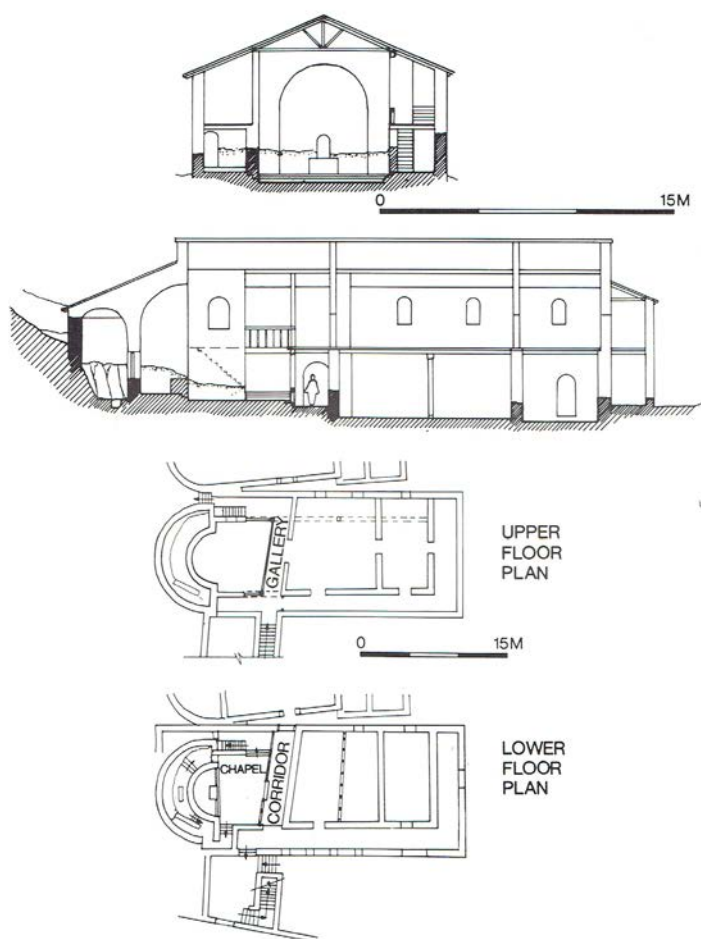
La Chiesa Sud nel IX secolo: pianta e ricostruzione degli alzati – ril. e dis. S. Gibson
